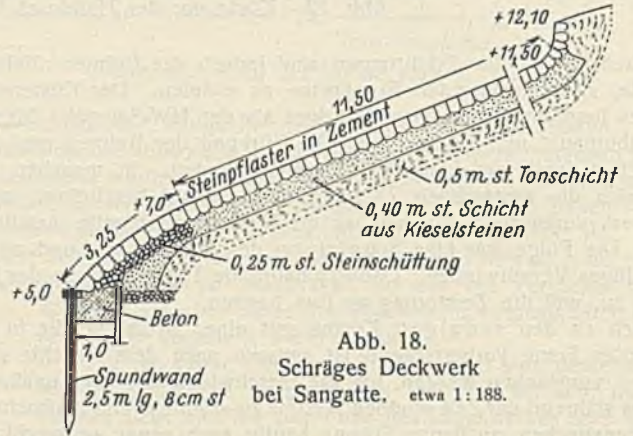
Schräges Deckwerk bei Sangatte. etwa 1 : 188.
